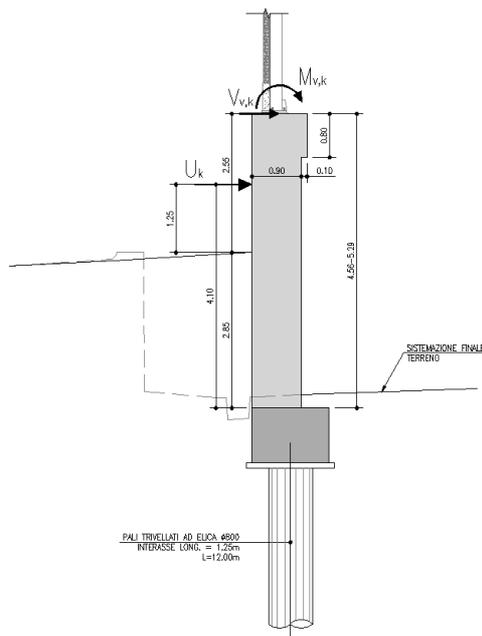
Schema delle azioni di progetto per la verifica dell'armatura allo spiccatto
